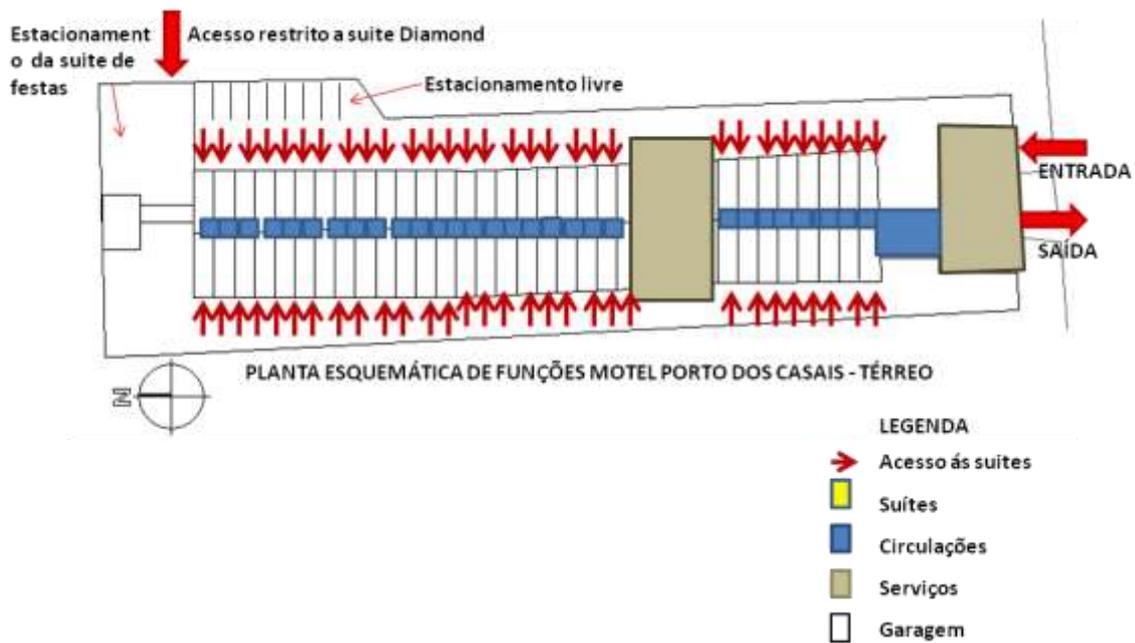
Planta esquemática do pavimento térreo (AUTORA, 2010).
